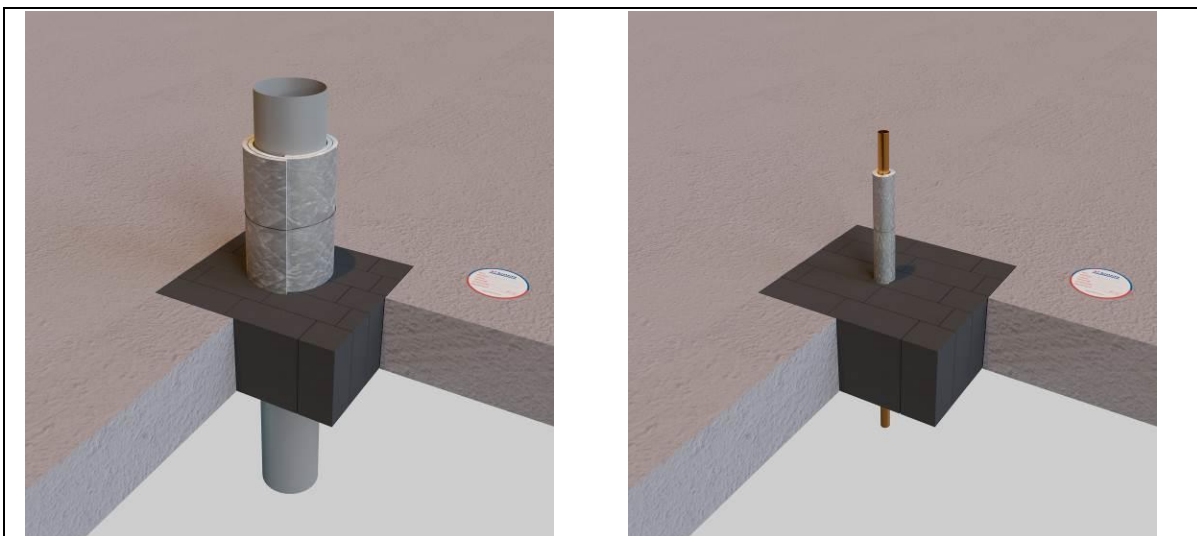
Esempi di sigillatura con AF BRICK di attraversamenti di tubazioni metalliche protette in solai.
